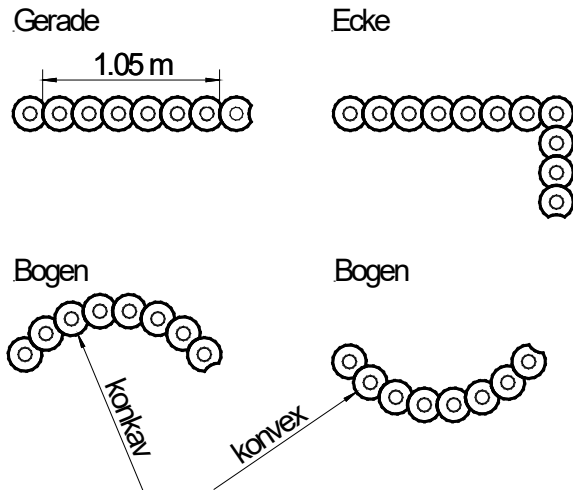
Mögliche Anordnungen von runden Betonhohlpalisaden
